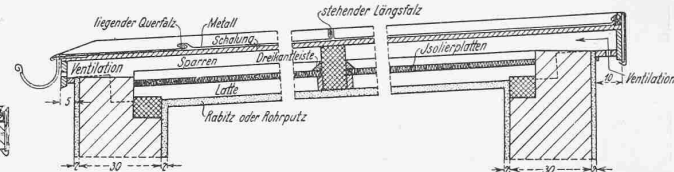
Holzdach mit Metalldeckung im Falzsystem. Gefälle 5‰.
